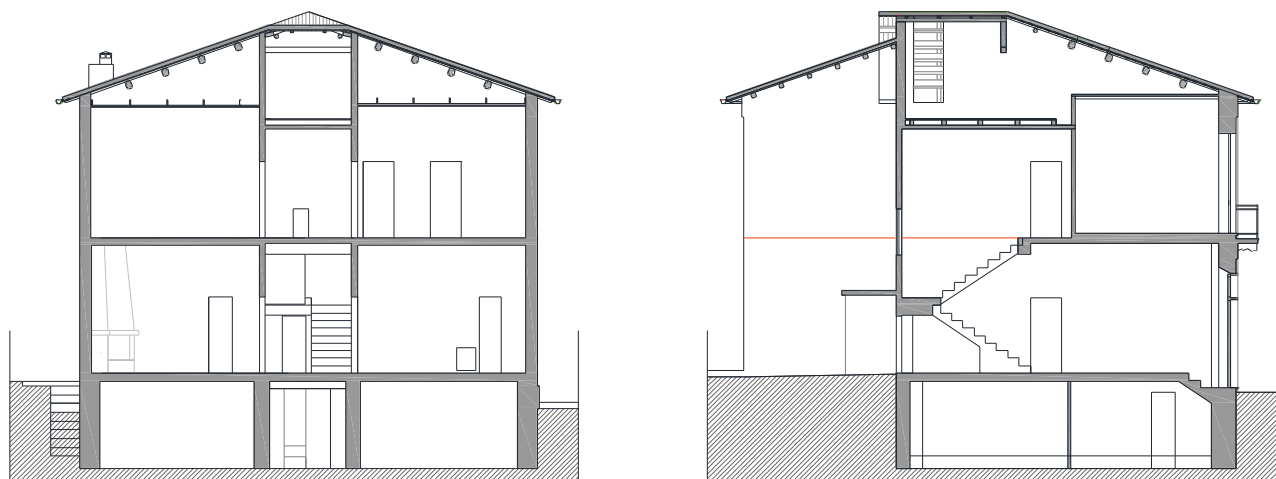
Prospetto sud (a) e prospetto nord (b)
